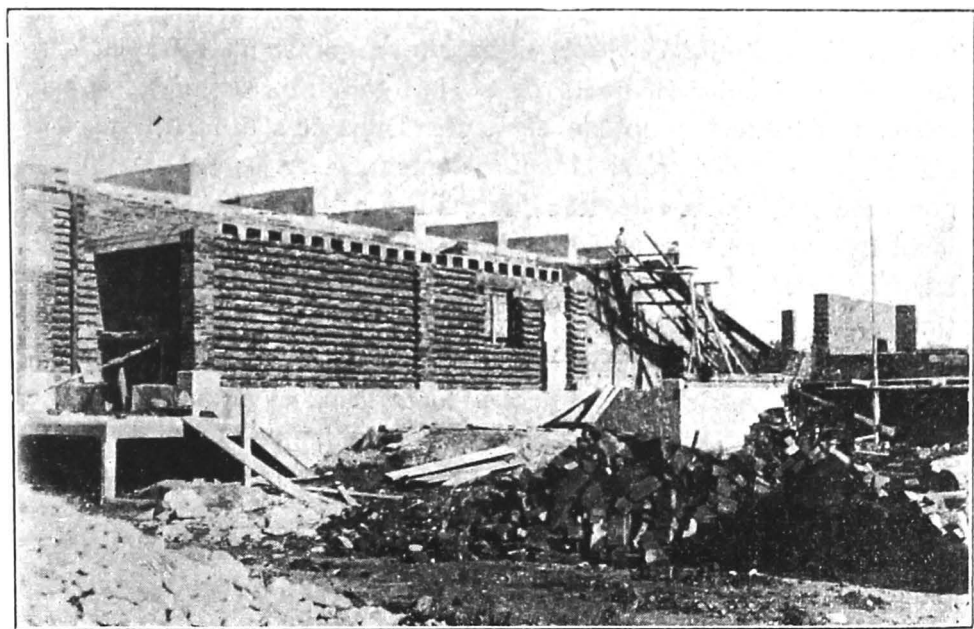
Arătarea celor două zeci de elemente constituind planșeul de beton armat deasupra depozitului de gheață la abatorul de frontieră de la Turnu-Severin.
